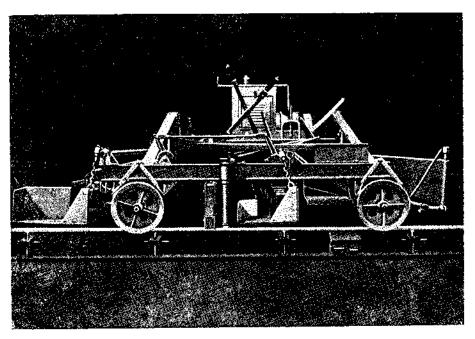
Боковой вид финишера Лейквуд (модель 1932 г.).
